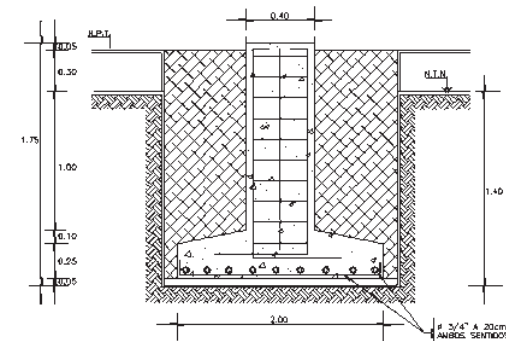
Detalle de zapata aislada. M. R. A. A.
